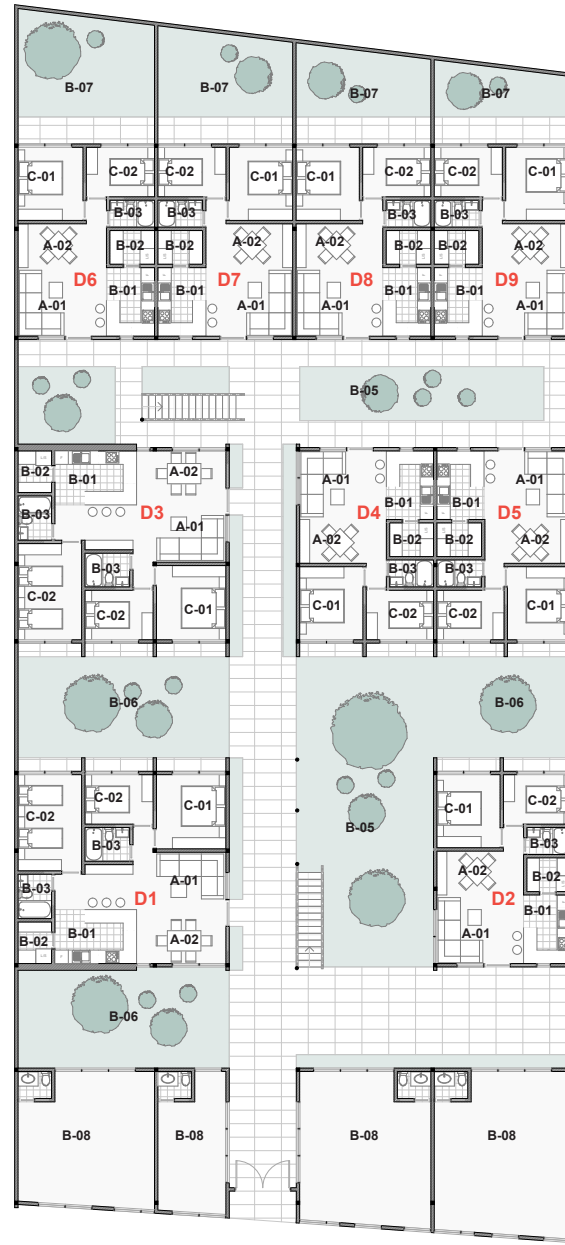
Planta Baja. Elaborado por Grupo de Tesis.
